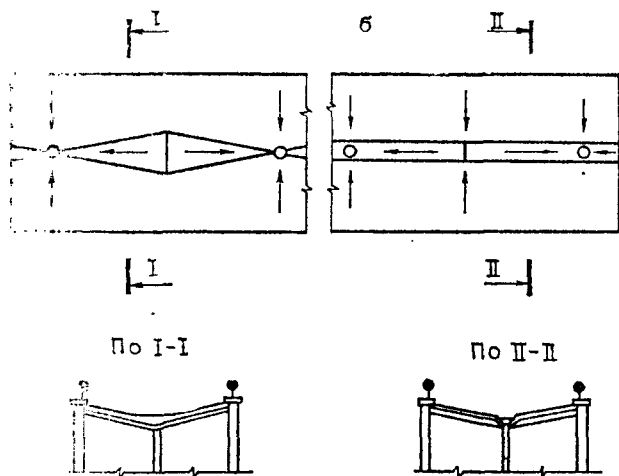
Схема устройства покрытия с внутренним водосток-ком
